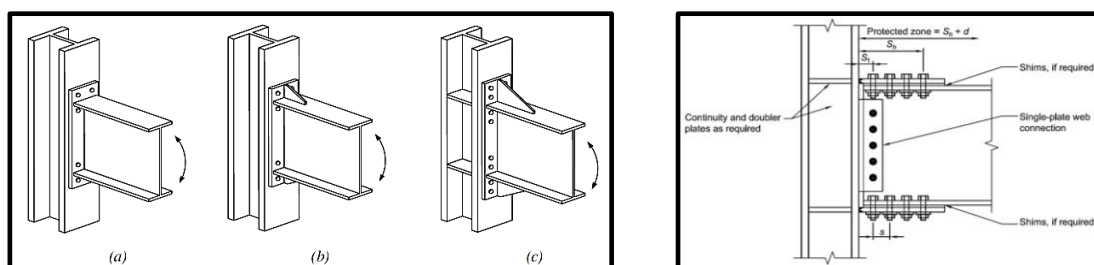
Conexiones precalificadas AISC 358-16 (End plate, izq., y Bolted Flange Plate, der.)
